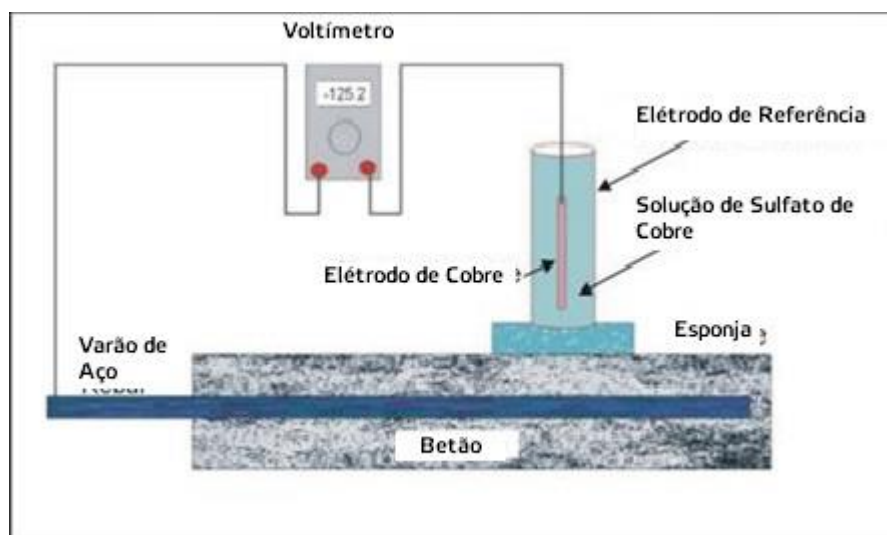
Deteção da corrosão das armaduras (adaptado de www.cflhd.gov).
